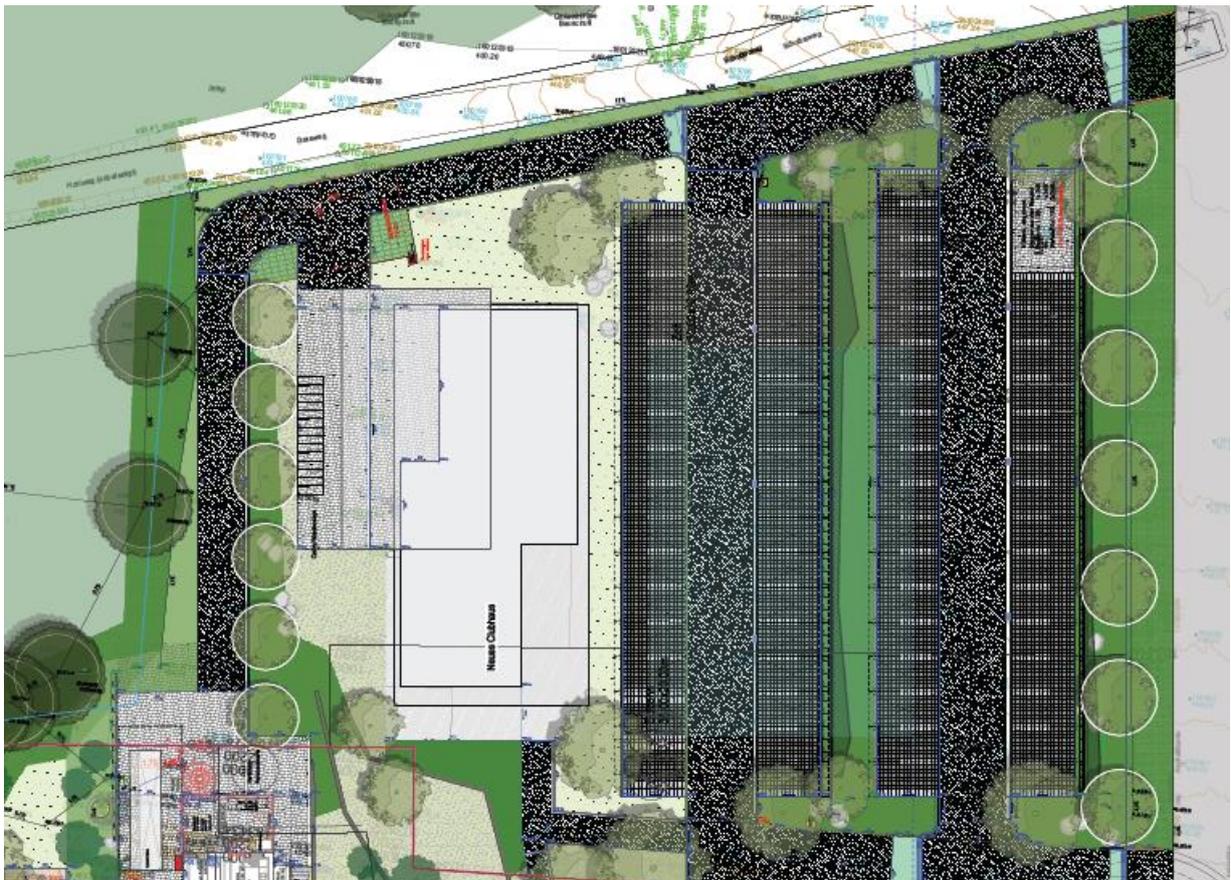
Vorabzug Lageplan der geplanten baulichen Veränderungen – Quelle: FREIRAUM Rabsilber Heckmann Giese Landschaftsarchitekten PartGmbH
